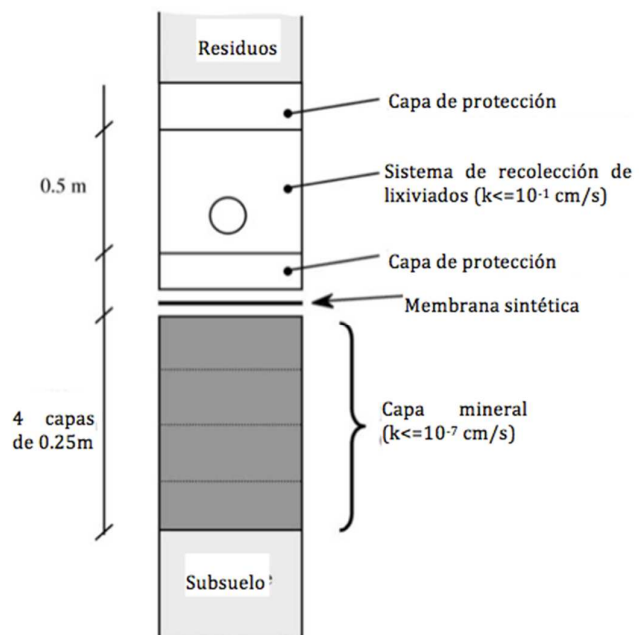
Ilustración del paquete impermeable y drenante [1]
